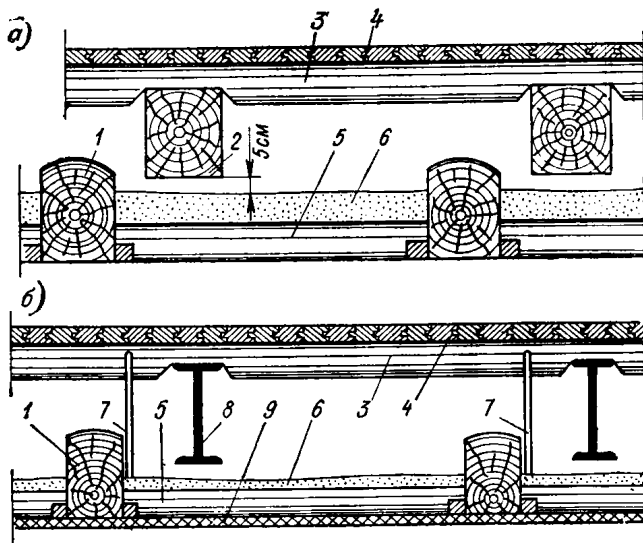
Примеры усиления существующего перекрытия путем устройства второго вышележащего перекрытия
